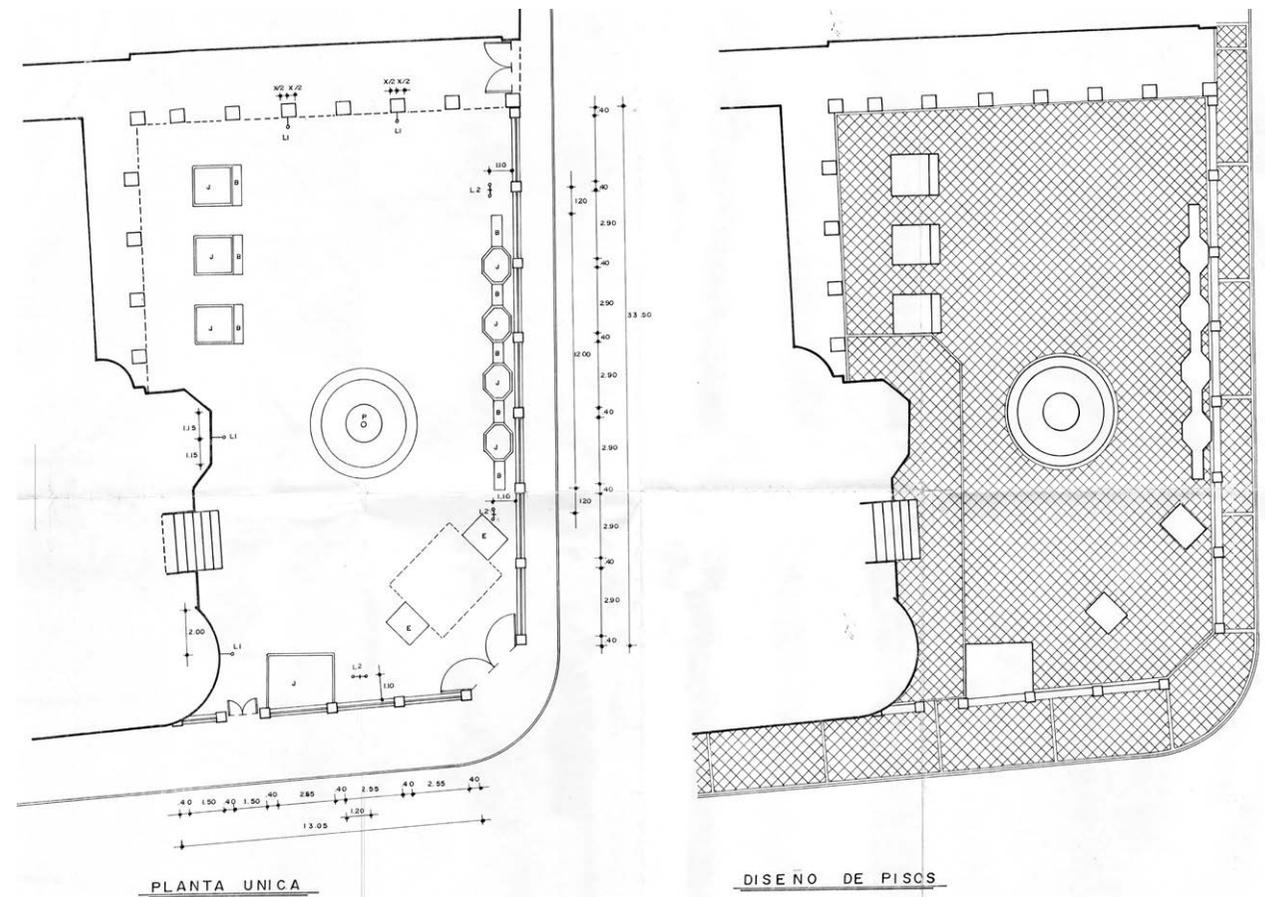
Planta arquitectónica de la Plaza de las Monjas, 1976- 1977
